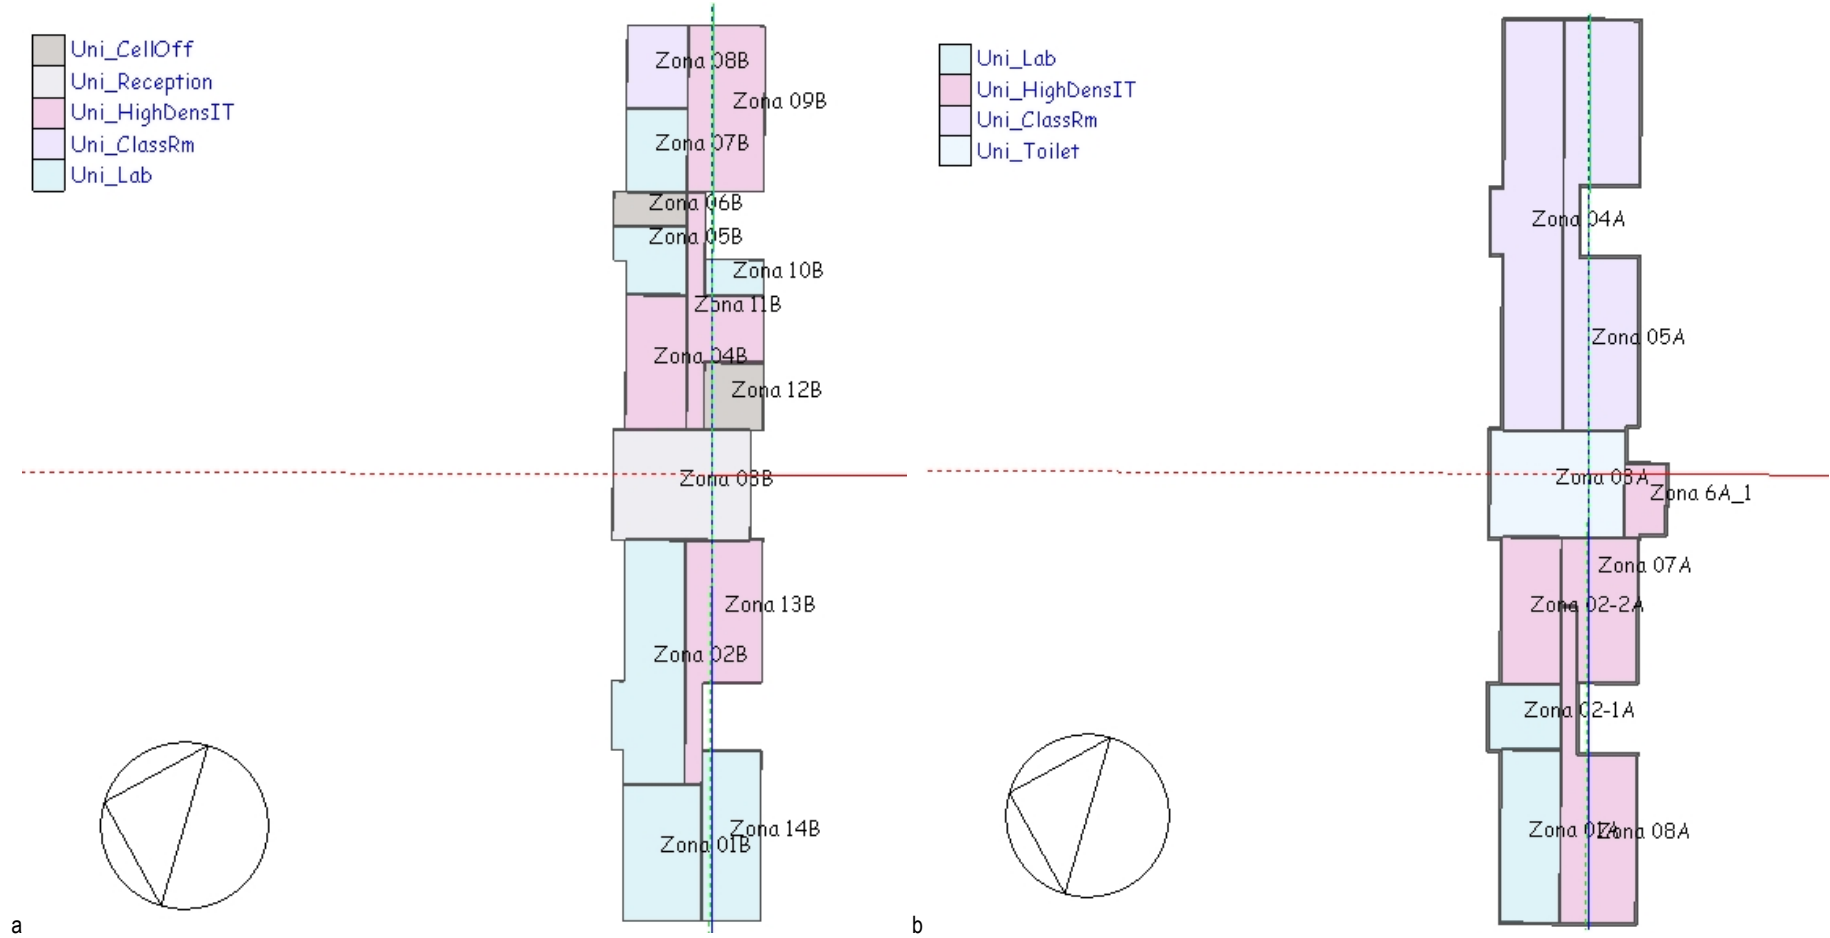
Multi-zonas térmicas edificio G1 *DesignBuilder*. a. planta baja; b. sótano.
